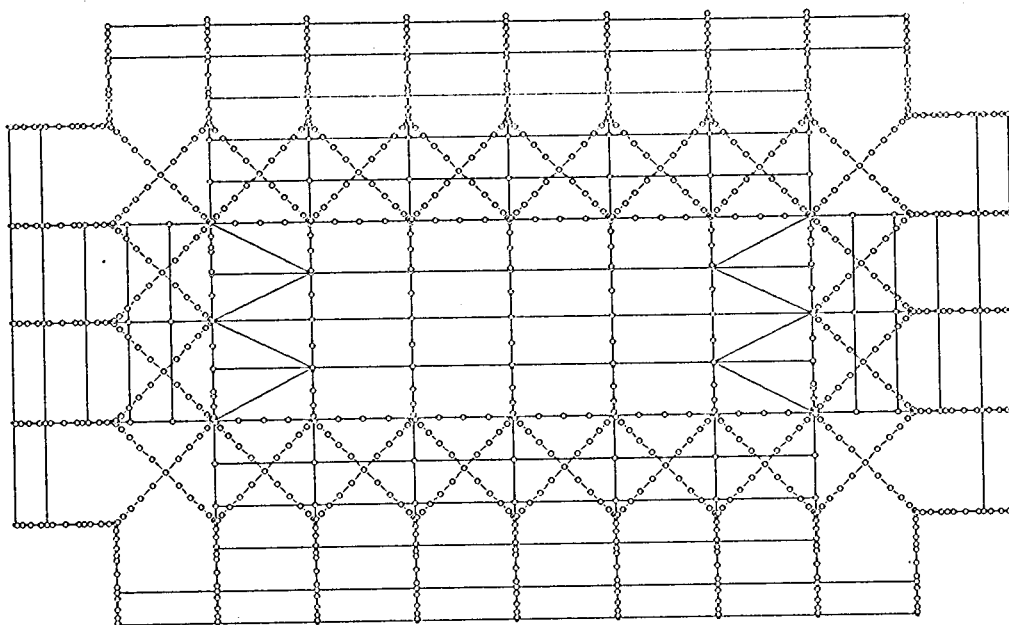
Shopgal. Modelação estrutural: planta.
